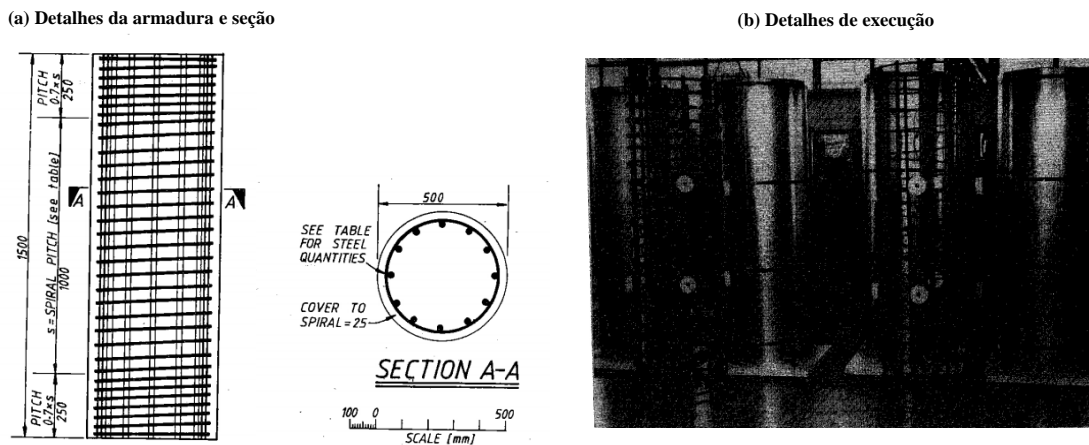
Detalhes de armaduras, seção e execução dos pilares de Mander (Fonte: Mander, 1984)
